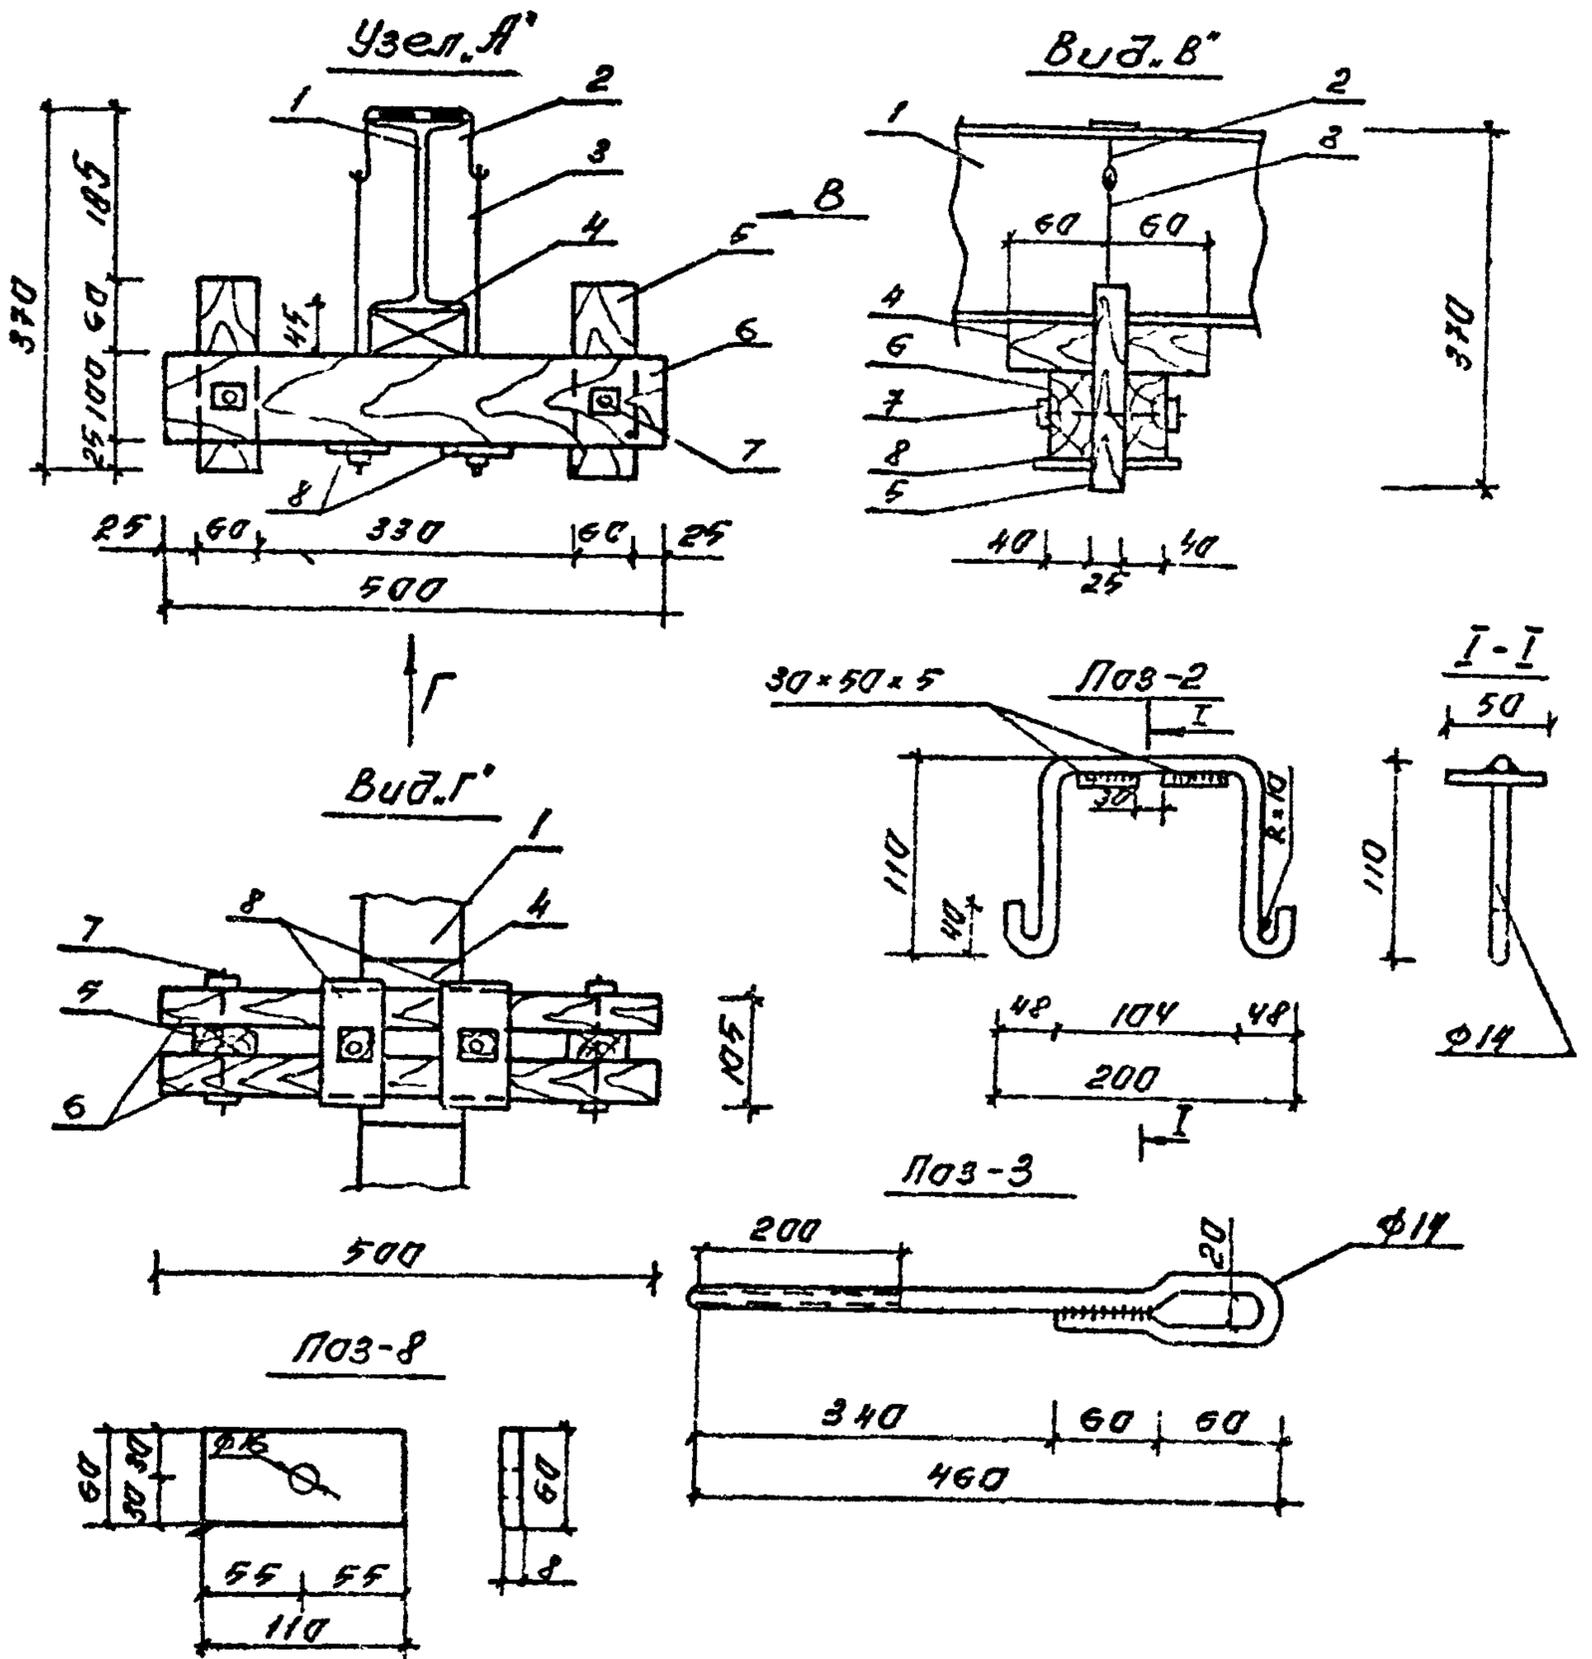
Подвесная опора и комут. Вариант по металлическим балкам перекрытия.
